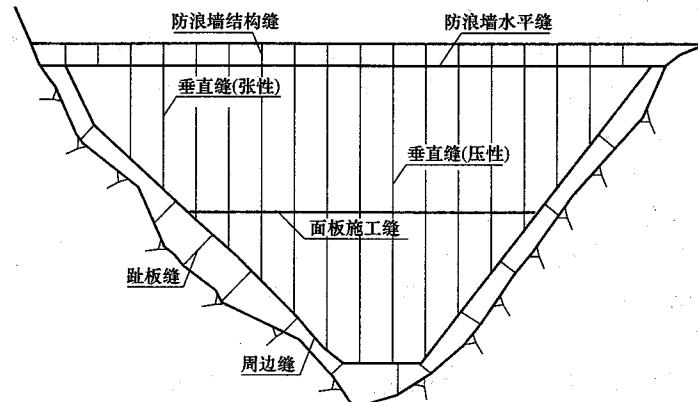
混凝土面板堆石坝接缝示意图（上游立视图）
